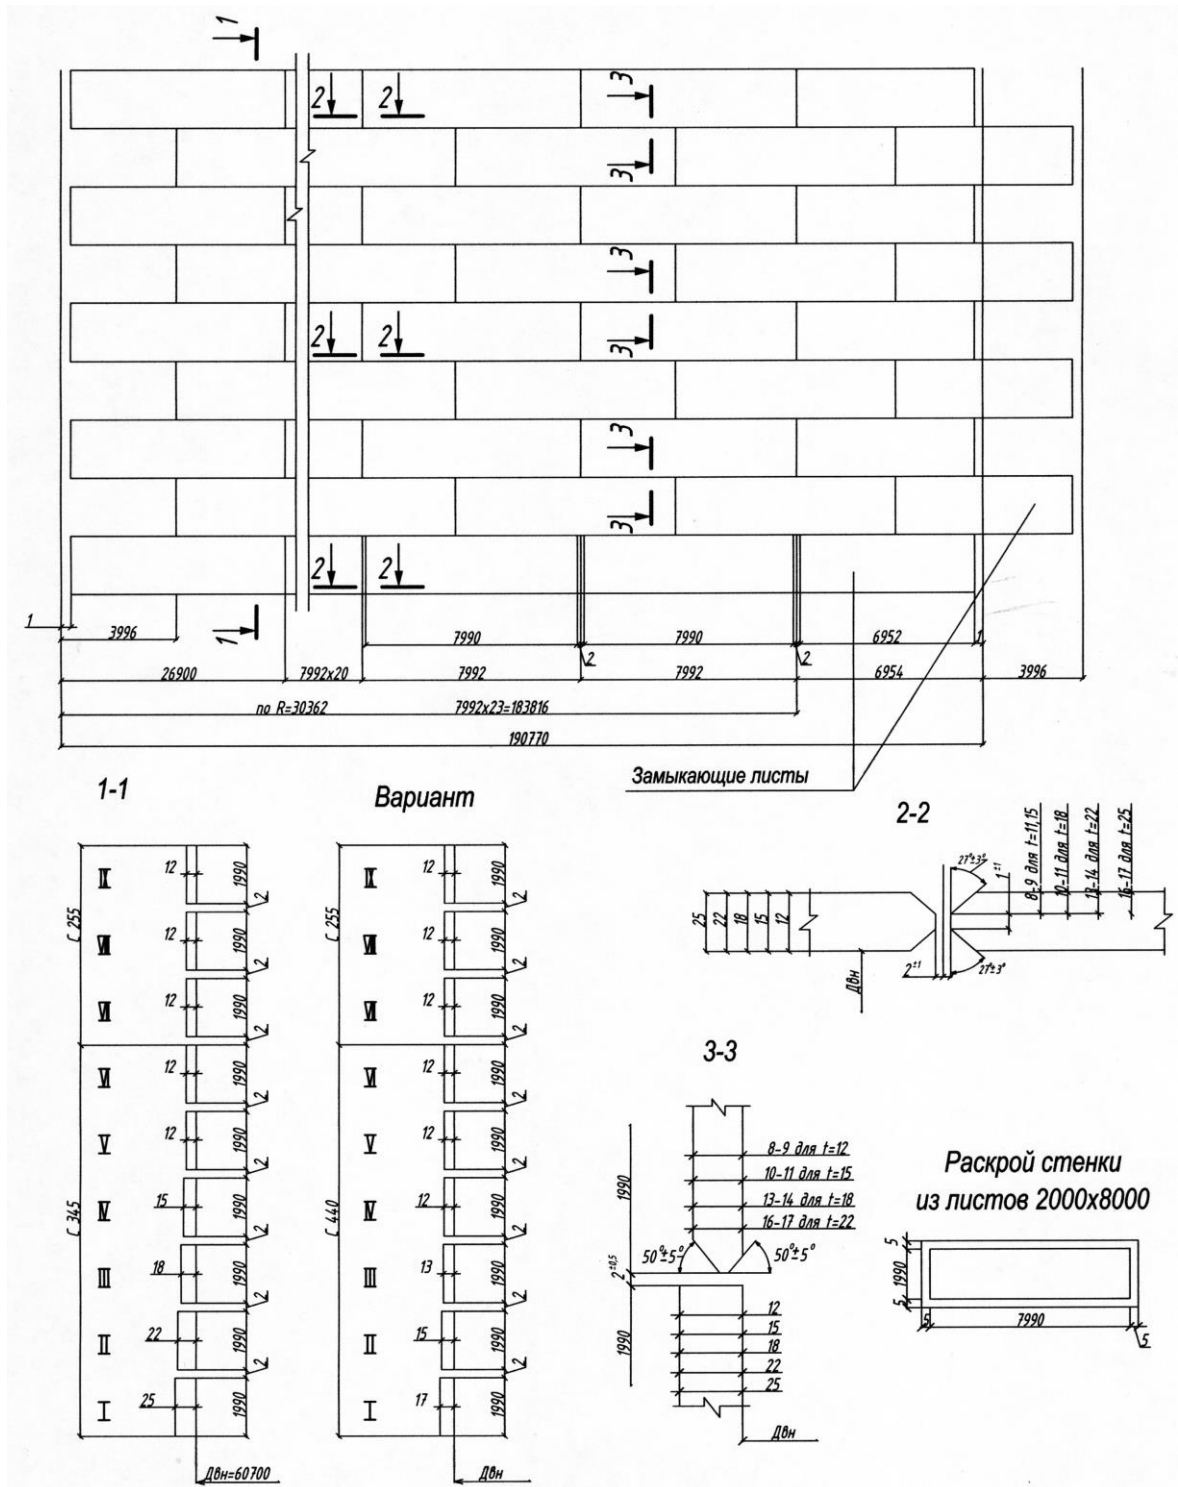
Развёртка стенки полистовой сборки резервуара объёмом 50000 м³
